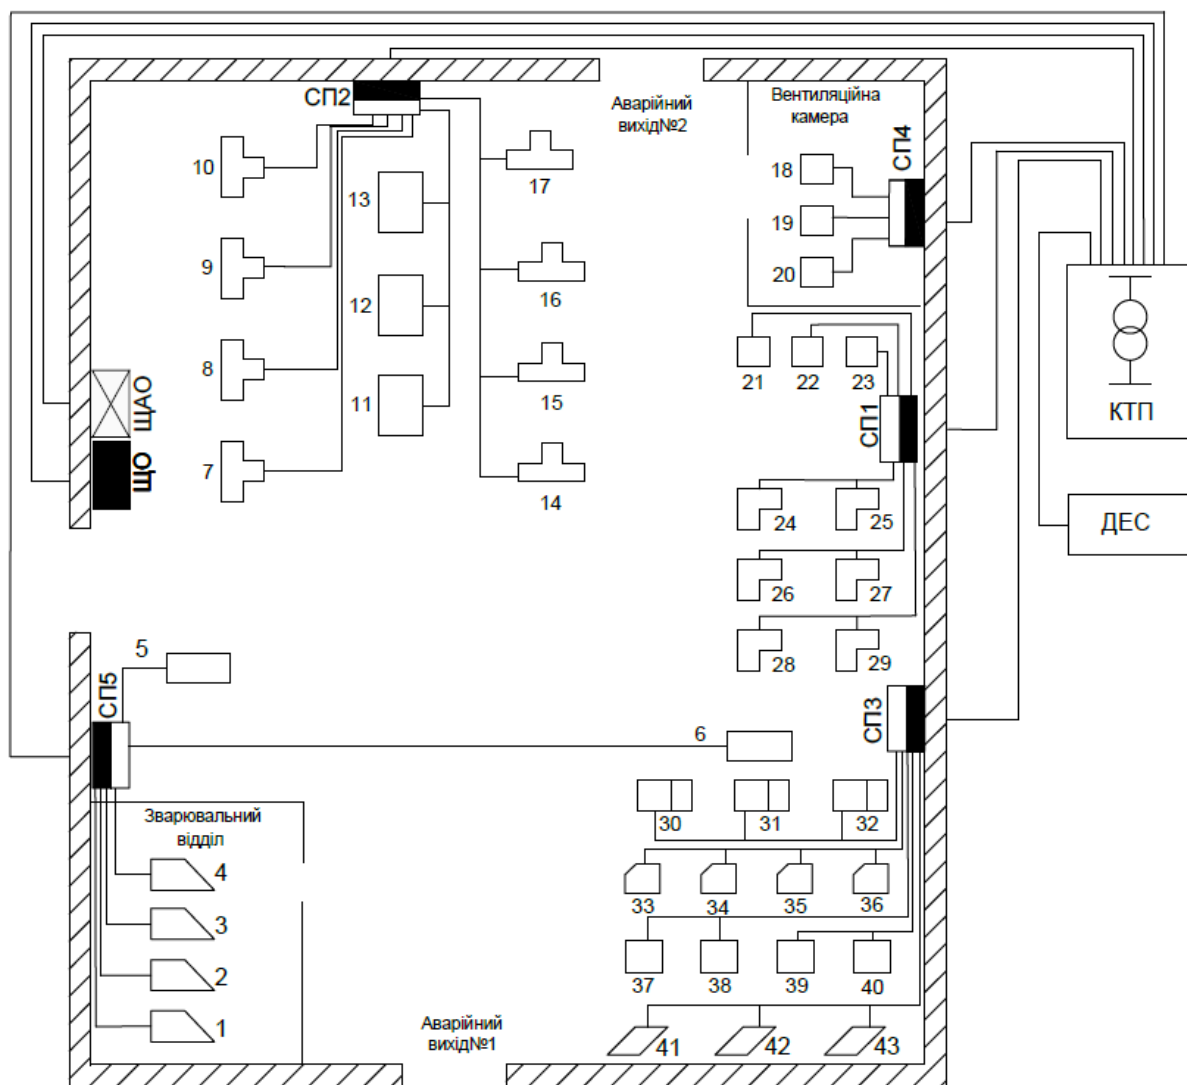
Генеральний план зварювального цеху з розміщенням КТП, ДЕС та схемою прокладки КЛ
